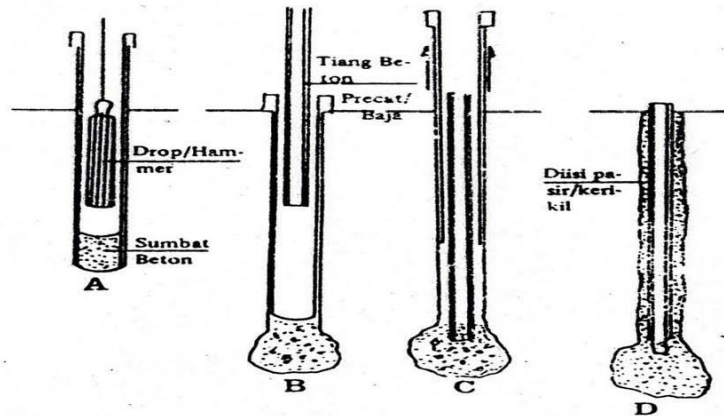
Tiang Pancang Composite Dropped – Shell and pipe pile
